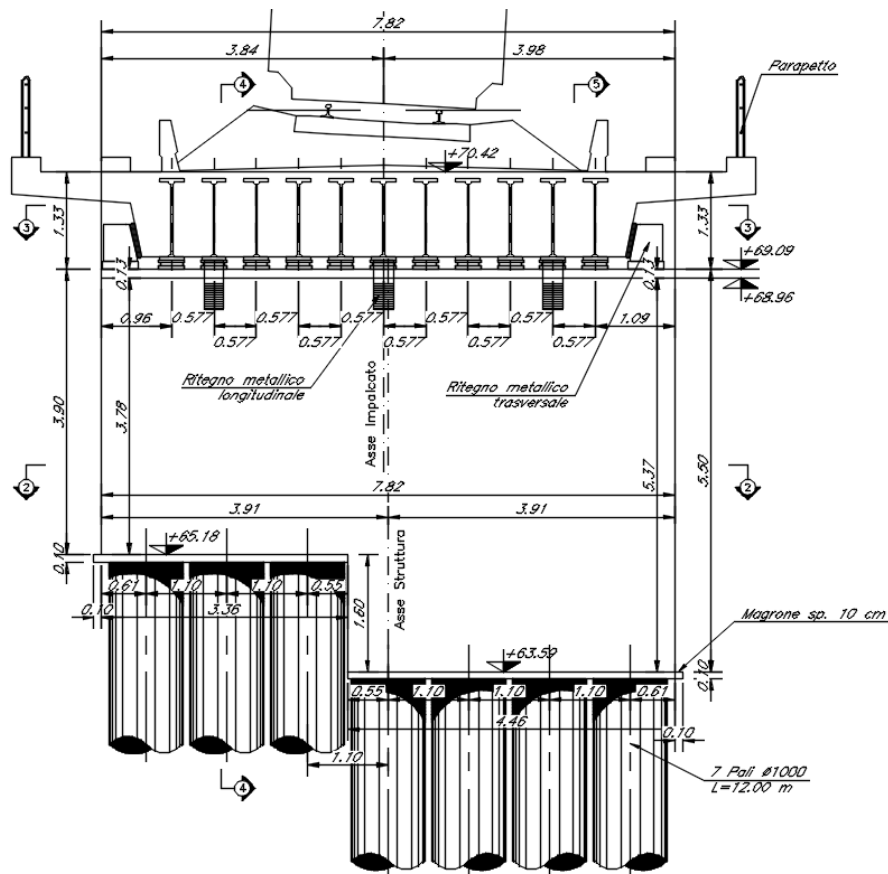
5 – Spalla P1 (spalla con appoggi “mobili”) - Sezione trasversale 1-1
